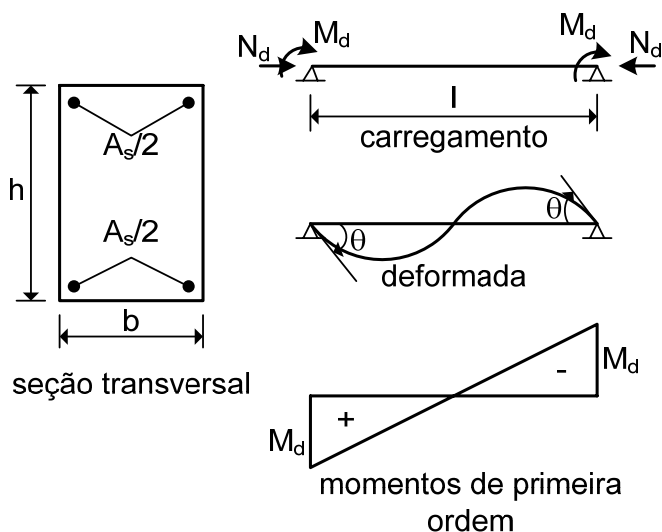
Seção transversal e carregamento das vigas e pilares
